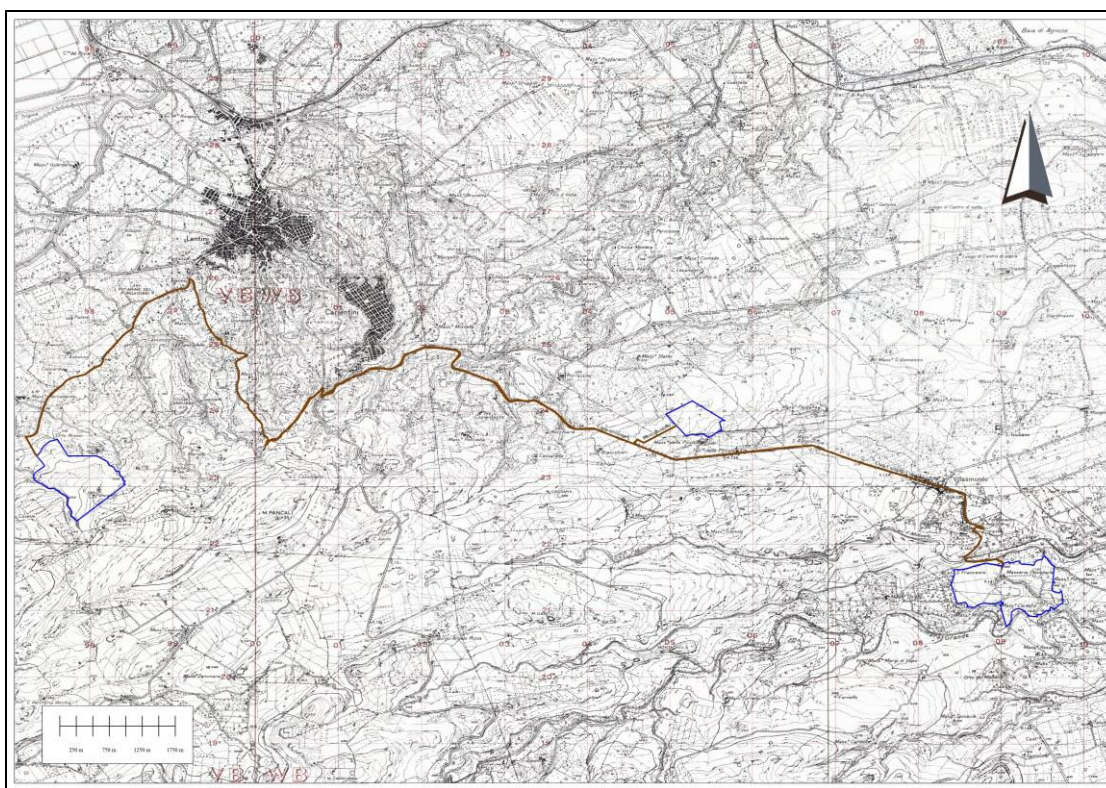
stralcio planimetrico su IGM del layout di impianto
